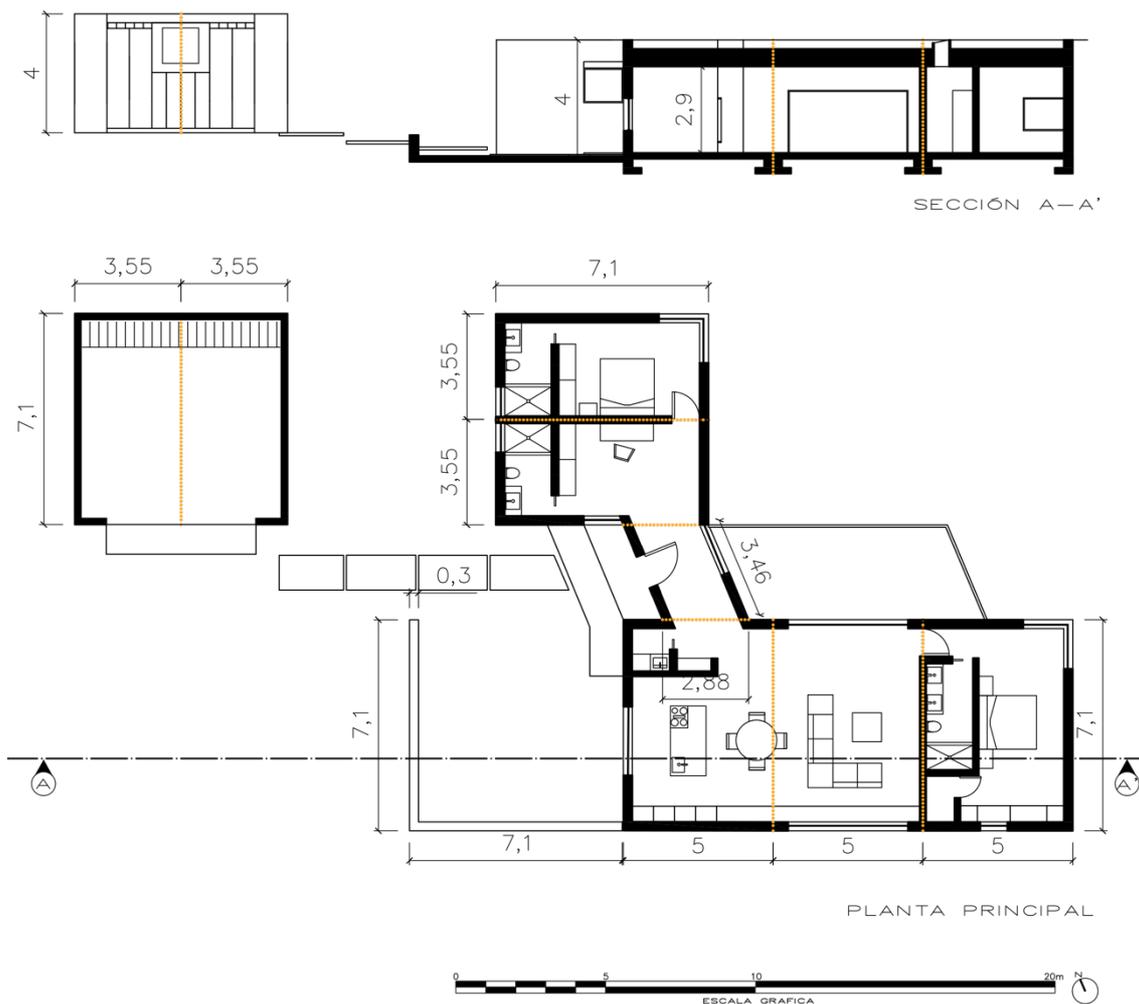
Planta principal y sección modificadas para facilitar la modulación de la vivienda
